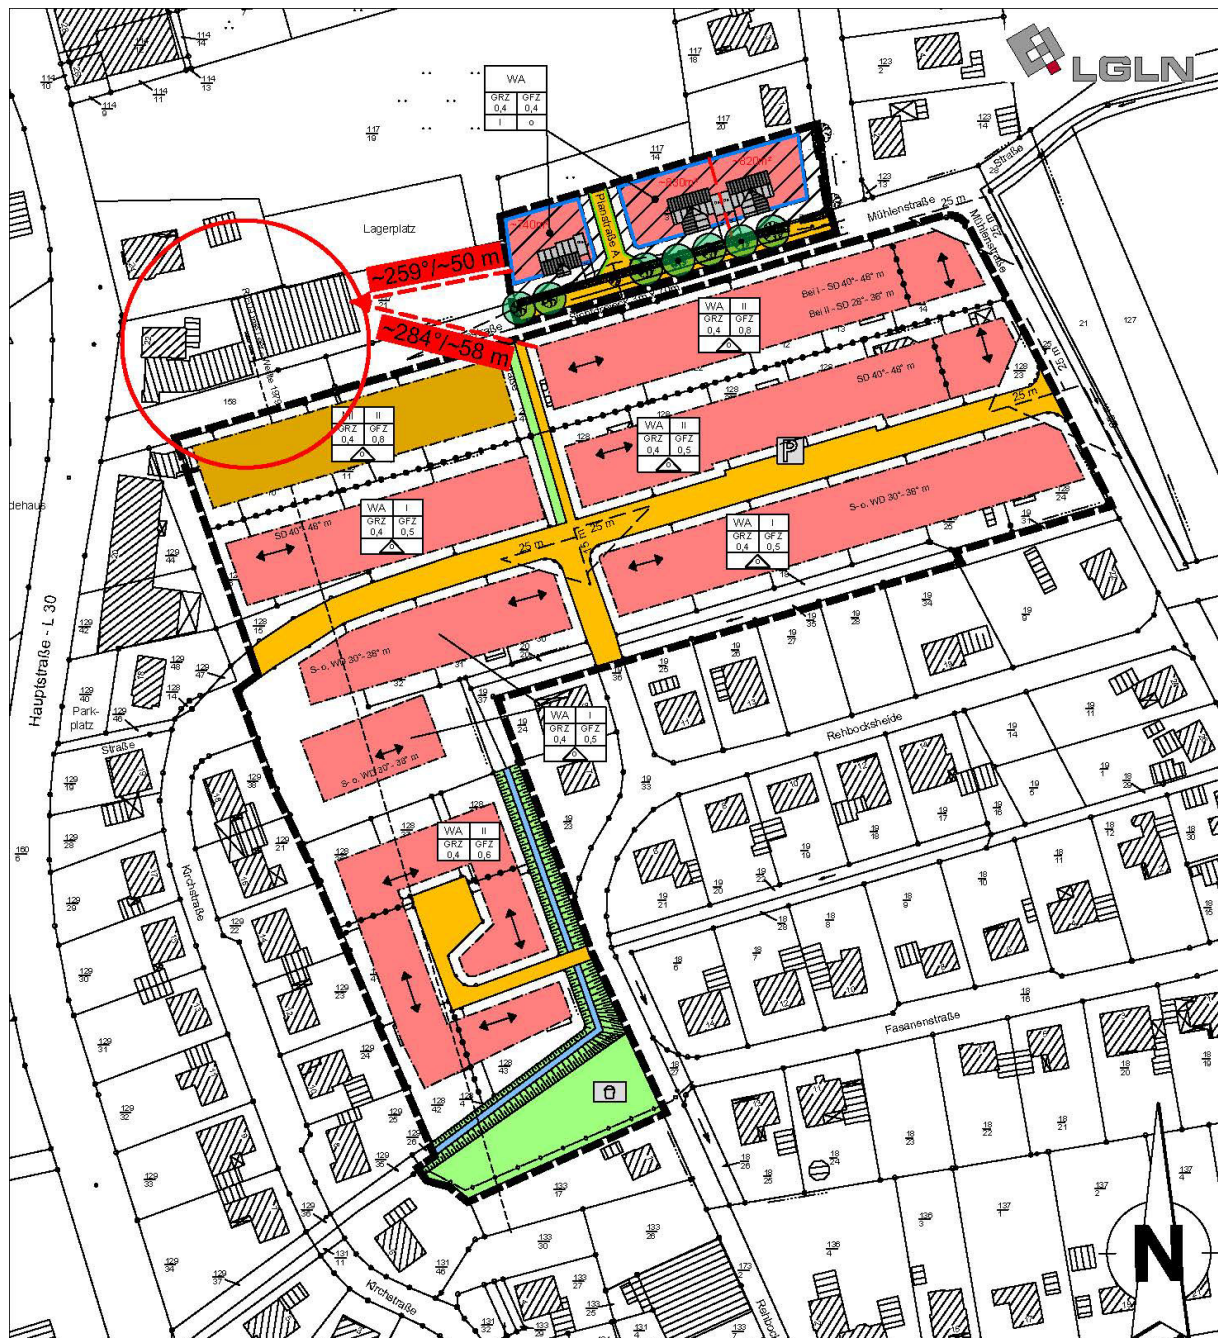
Gestaltungsplan mit Abstand Lagerhalle BPlan Nr. 17 und BPlan Nr. 7)
